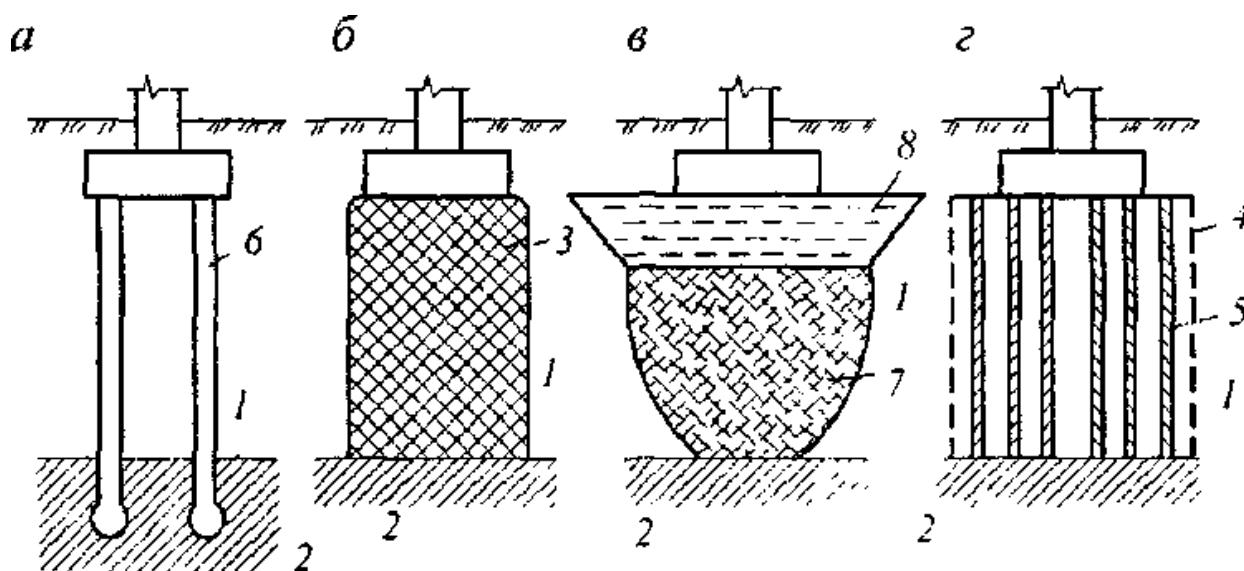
Различные варианты устройства оснований и фундаментов в грунтовых условиях при II типе просадочности: 1 - просадочный грунт; 2-непросадочный грунт; 3 - закрепленный грунт; 4 - зона уплотнения грунтовыми сваями; 5 - грунтовые сваи; 6 – сваи; 7 - уплотненный грунт; 8 - грунт, уплотненный тяжелыми трамбовками
